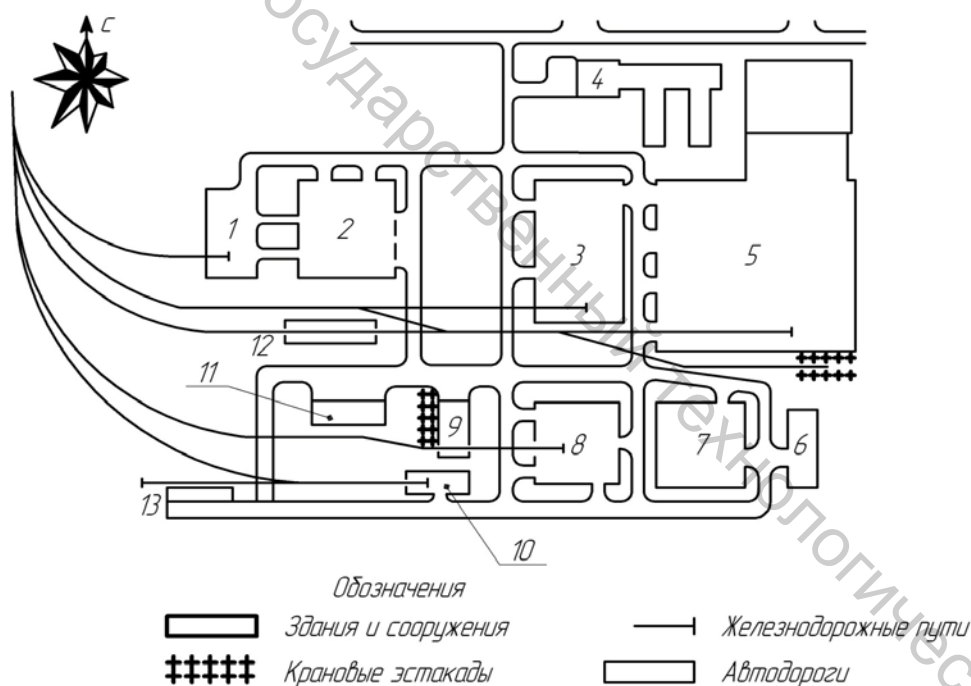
Схема генерального плана станкостроительного завода: 1 – склад лесопиломатериалов; 2 – деревообрабатывающий корпус (с тарным цехом); 3 – корпус тяжелых станков; 4 – инженерно-лабораторный корпус; 5 – главный корпус (с термоконстантным цехом); 6 – склад узлов и запчастей; 7 – корпус вспомогательных цехов; 8 – корпус заготовительных цехов; 9 – склад металла и заготовок; 10 – склад отливок и поковок; 11 – главный магазина; 12 – склад готовой продукции; 13 – склад горючесмазочных материалов
